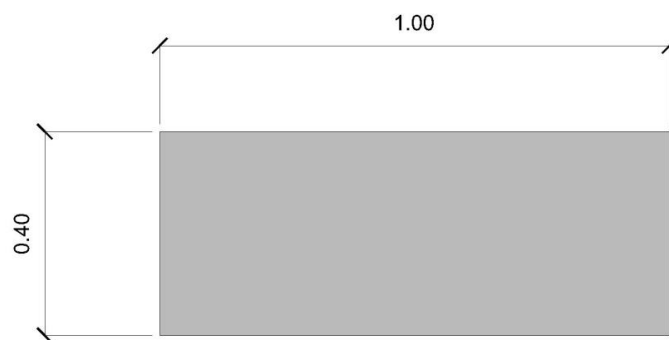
Alçado longitudinal da Viga B (dimensões em m)
